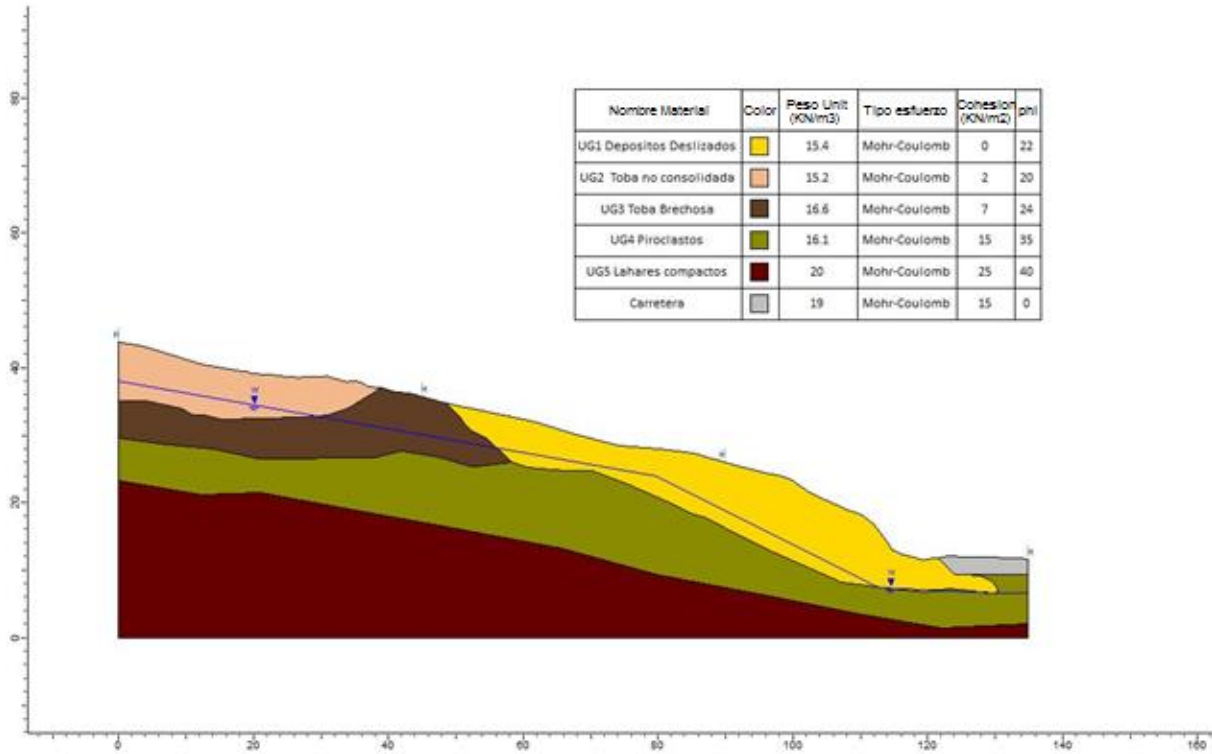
Perfil Geotécnico B1-B1'. Fuente: Elaboración propia.
